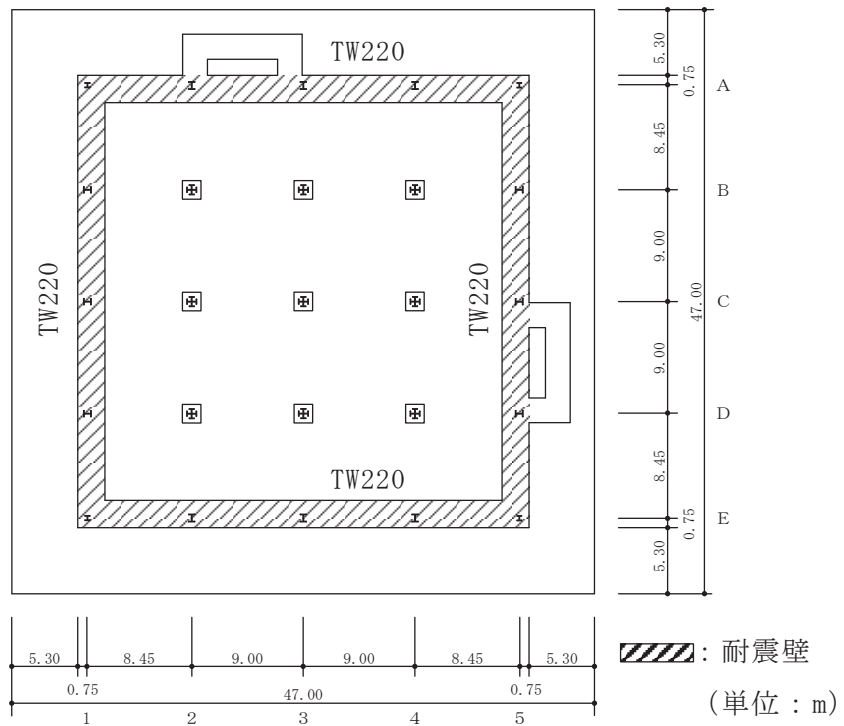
(1) 評価対象とする耐震壁 (B2F, 0.P. 51.5m)
